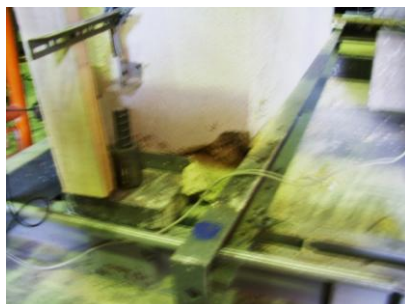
Fissura da base Oeste (O) da parede NA-3
